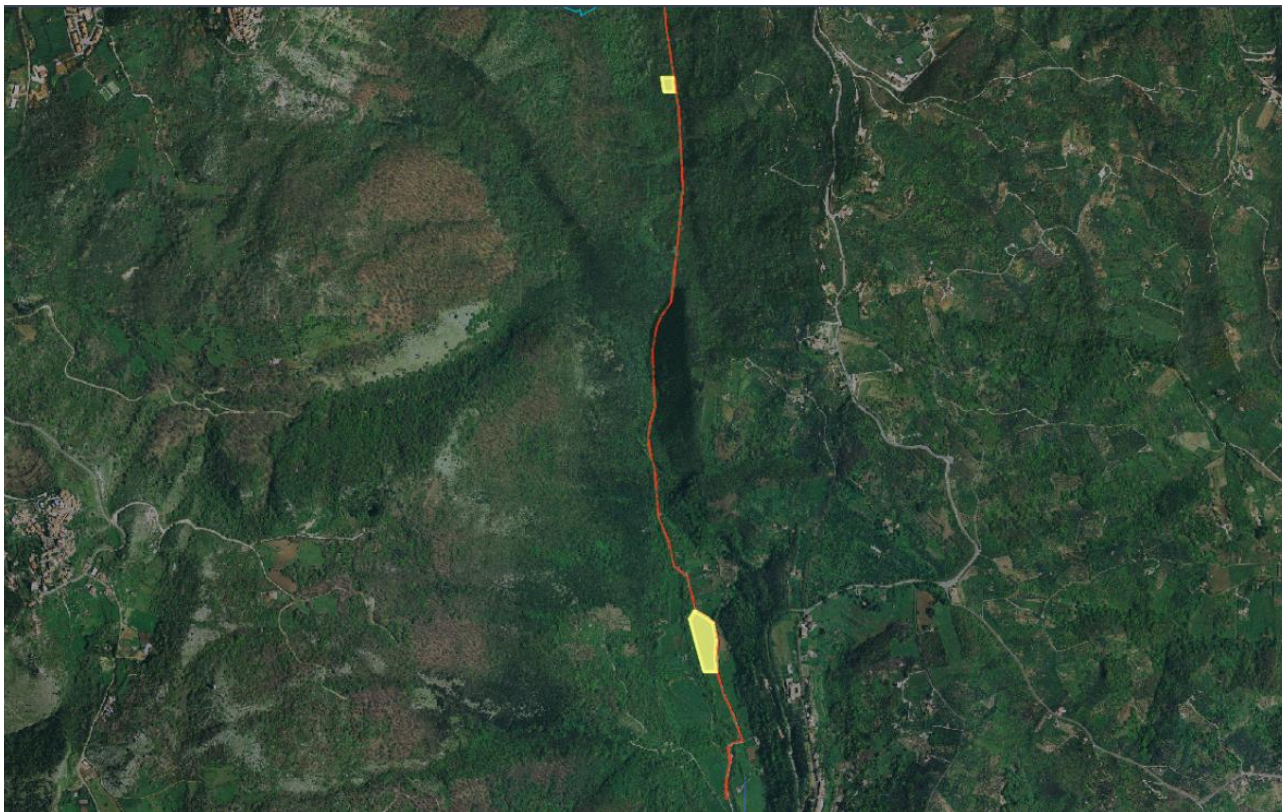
Tratto A, porzione sud Cantieri (giallo), tracciato in progetto (rosso)
